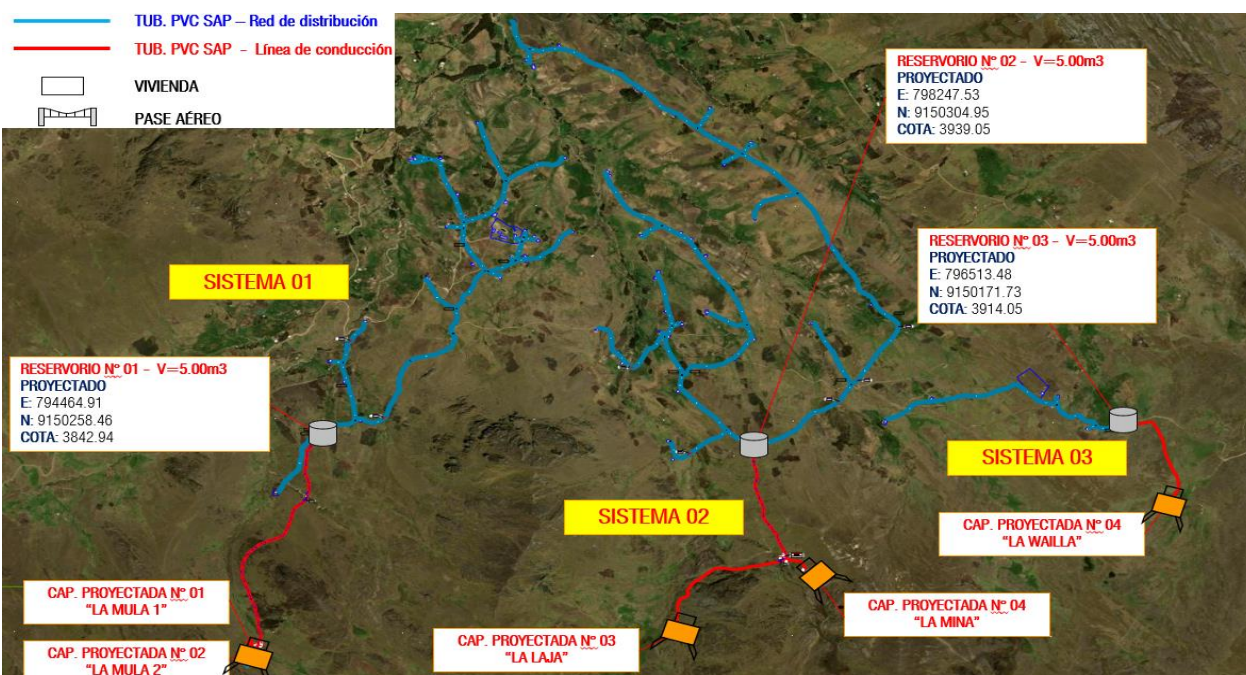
Croquis del planteamiento general proyectado del sistema de agua potable - Los Ángeles.
